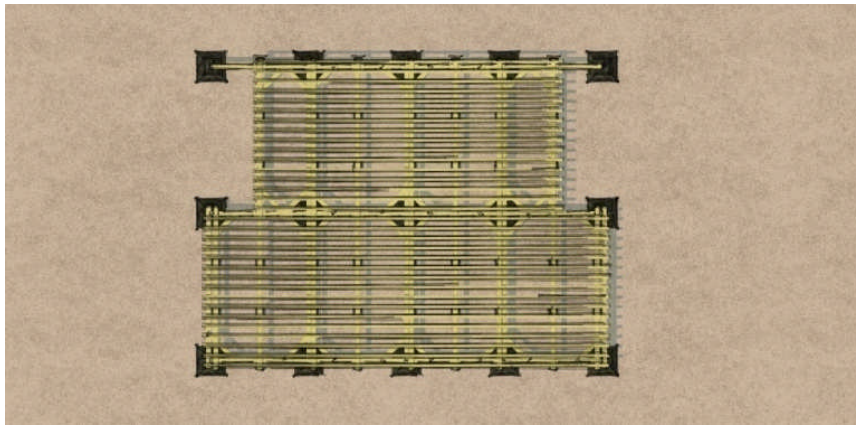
9. Denah Pondasi Batu Kali dan Sloof
